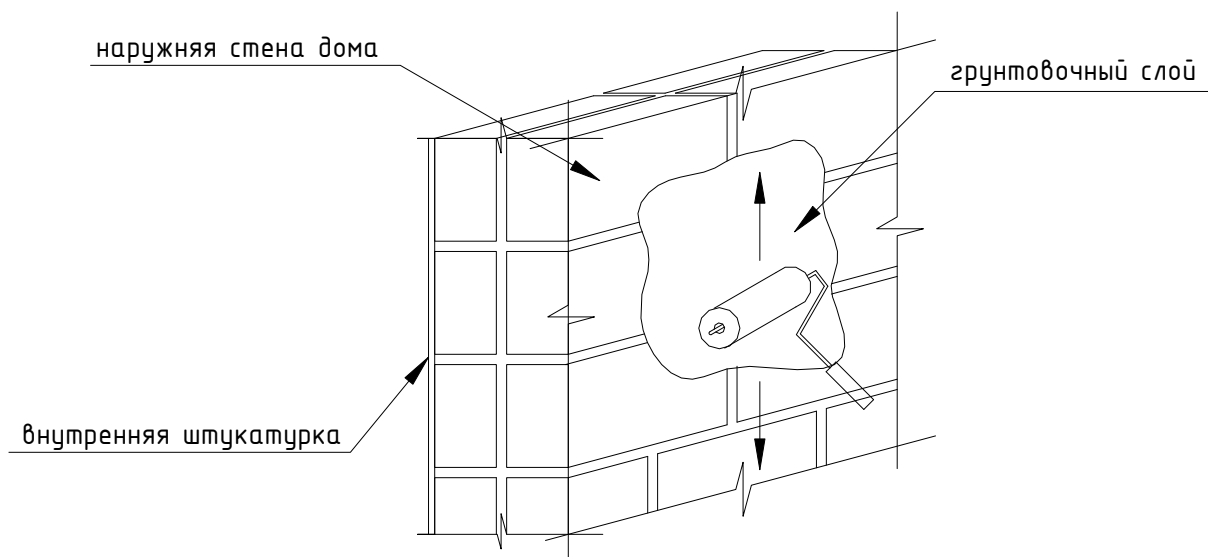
Нанесение грунтовки на наружную поверхность стены
